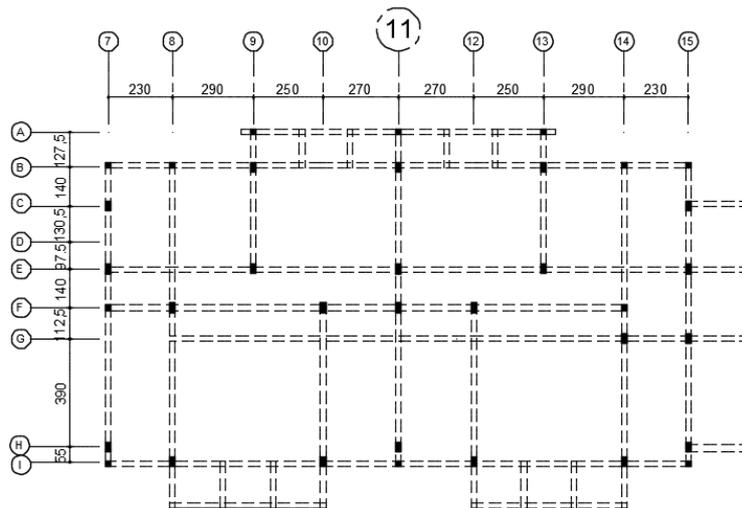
Descente des charges - Vue en plan pour l'étage courant du bloc B
